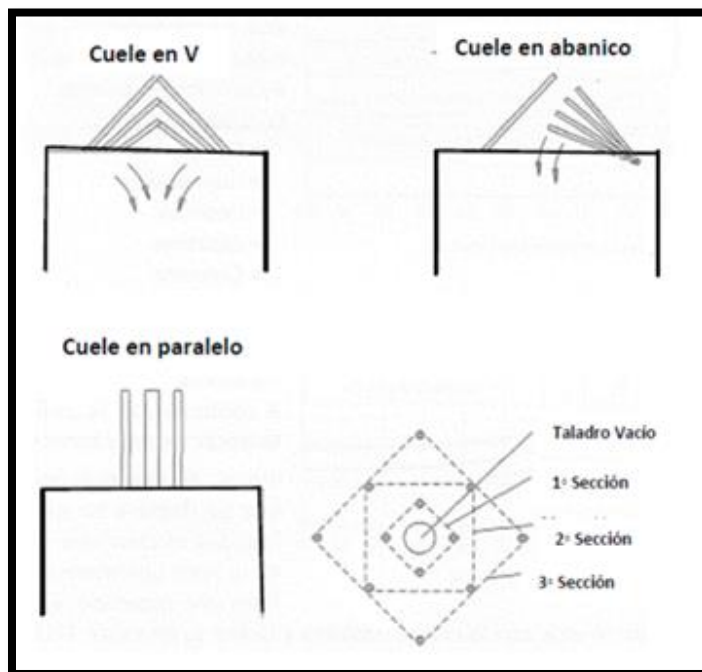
Sistema de avance en túneles (Fuente: Manual de P y V, López Jimeno).
